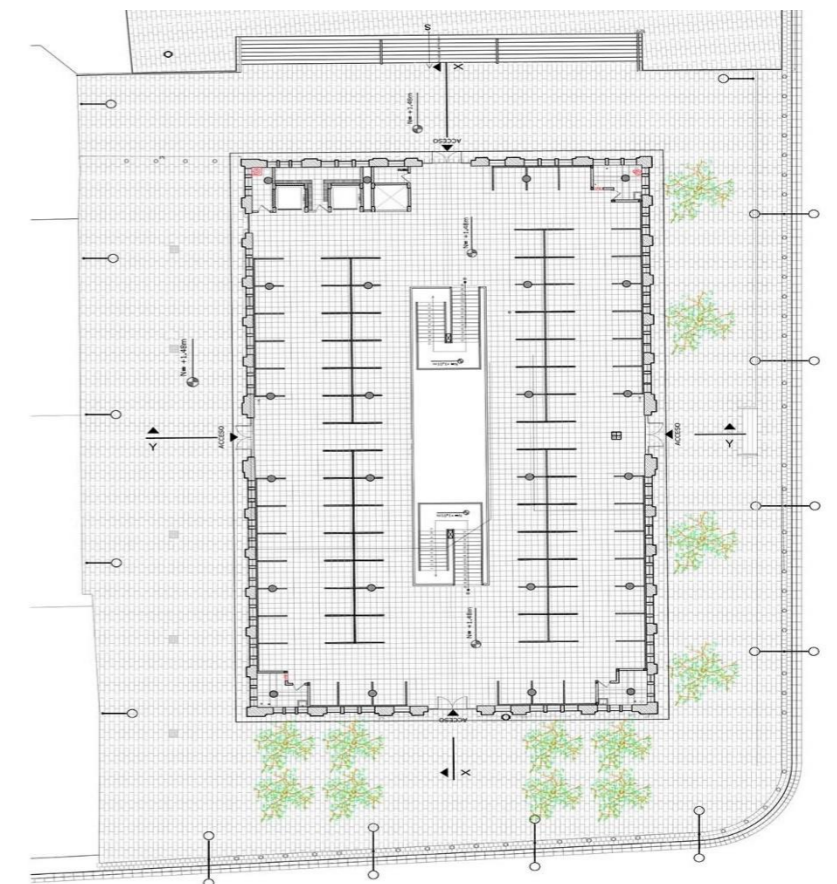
Mercado 9 de octubre. Distribución y estructura.
